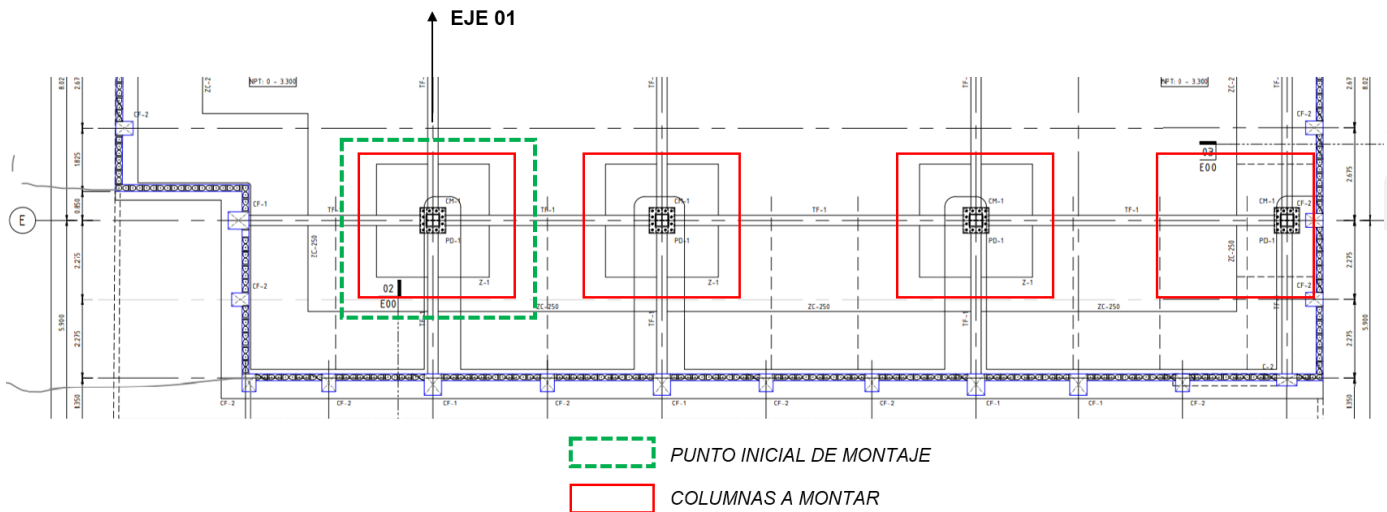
Detalle de ubicación de columnas CM-1 a montar.
